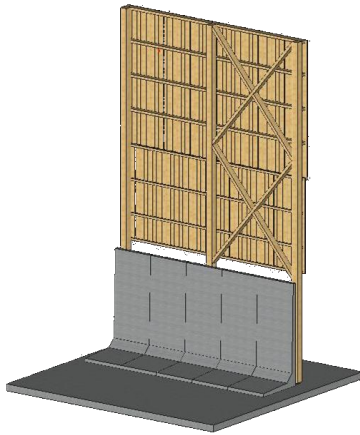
La structure avec le soutènement en L béton préfabriqué de l'intérieur
